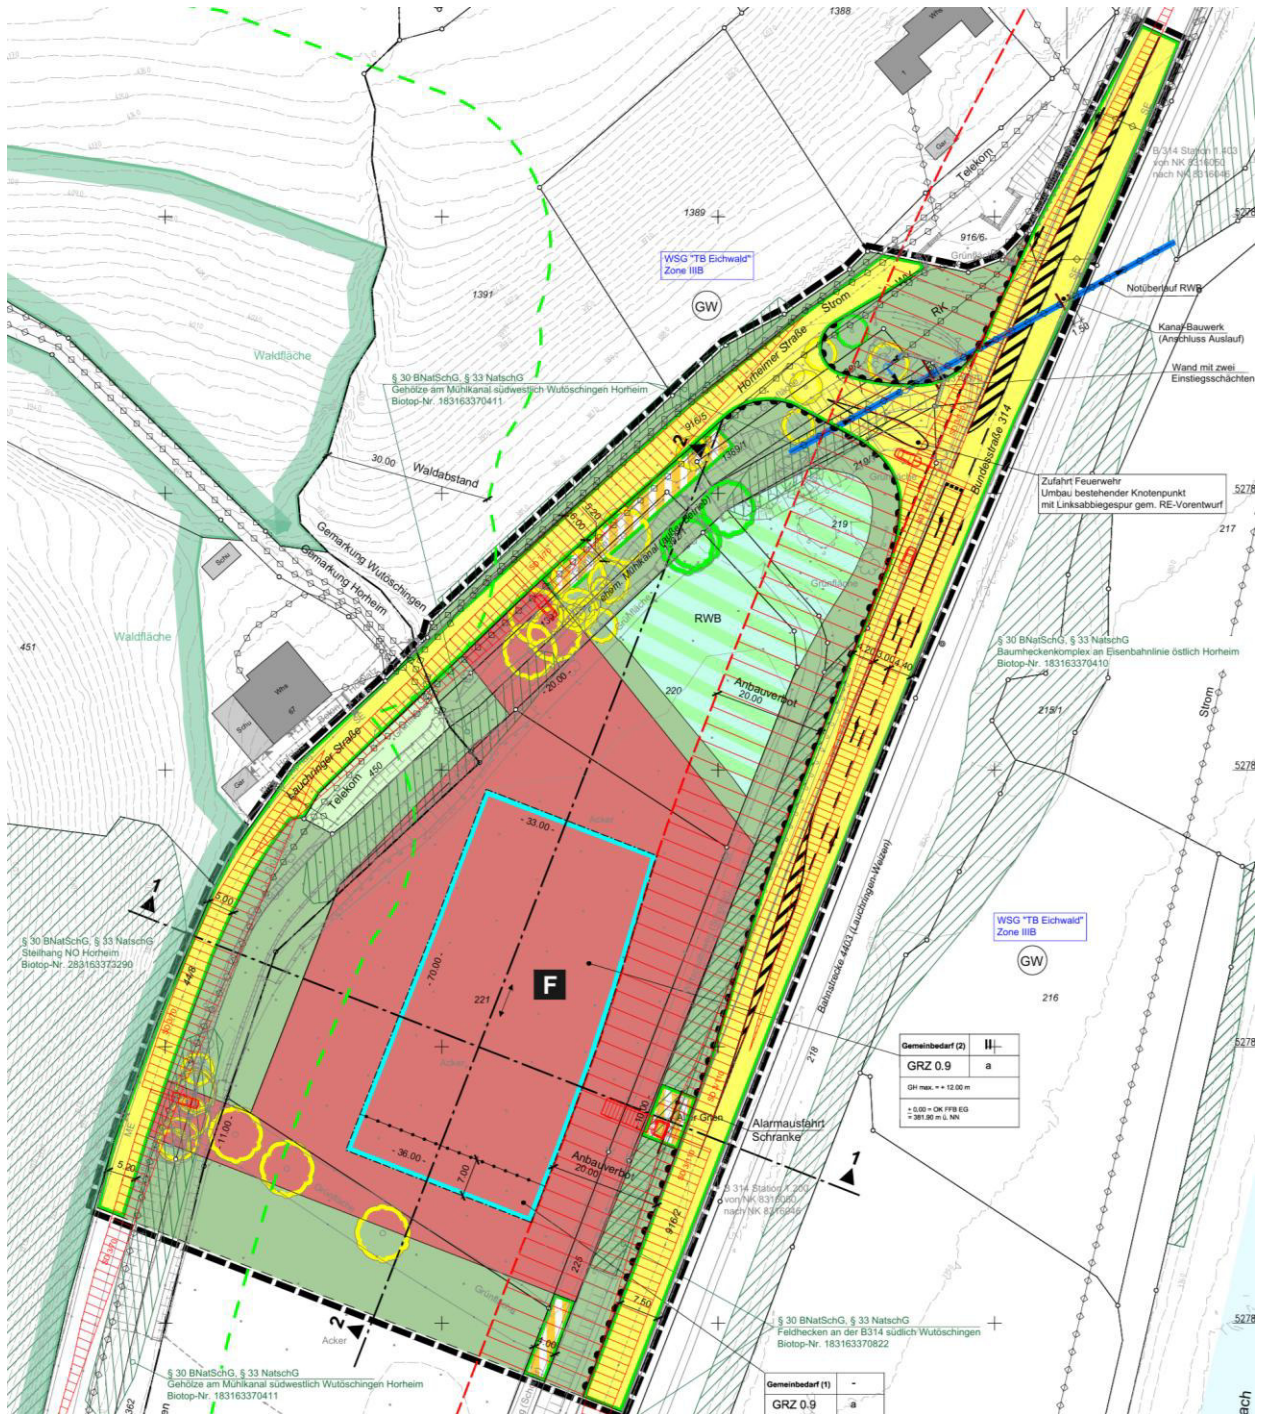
Plangebiet „Zentrales Feuerwehrgebäude“ (Ausschnitt aus Vorentwurf Fassung 23.02.2026)
